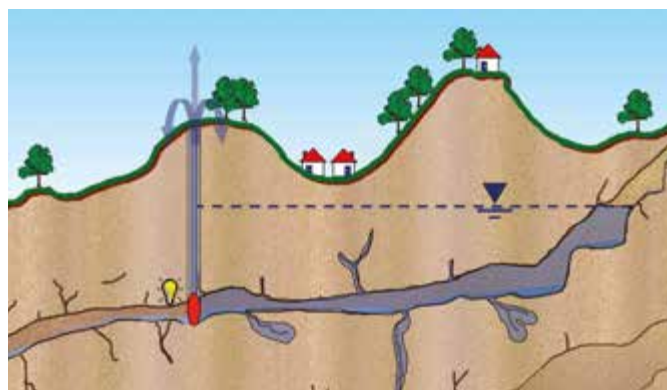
Wasserversorgung als „Perpetuum Mobile“ – Unterirdisches Betonsperrwerk (rot) mit Wasserkraftanlage in einer eingestauten Karsthöhle
